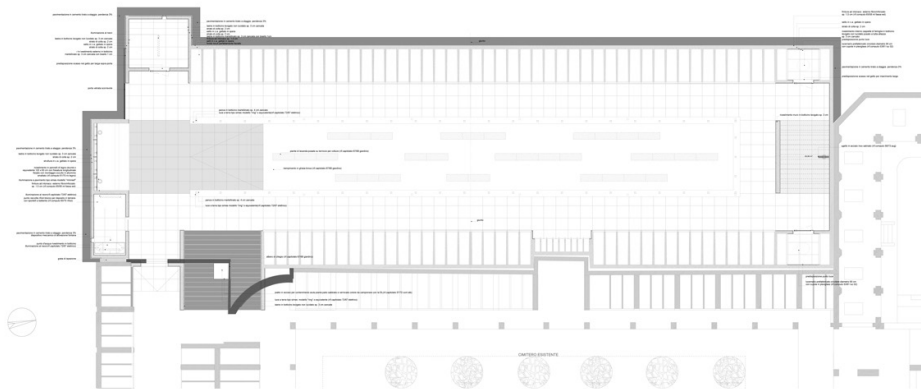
, 6 e 7 - Planimetria generale, pianta e aspetto esterno dell'ampliamento del Cimitero di Bagnolo Mella.
